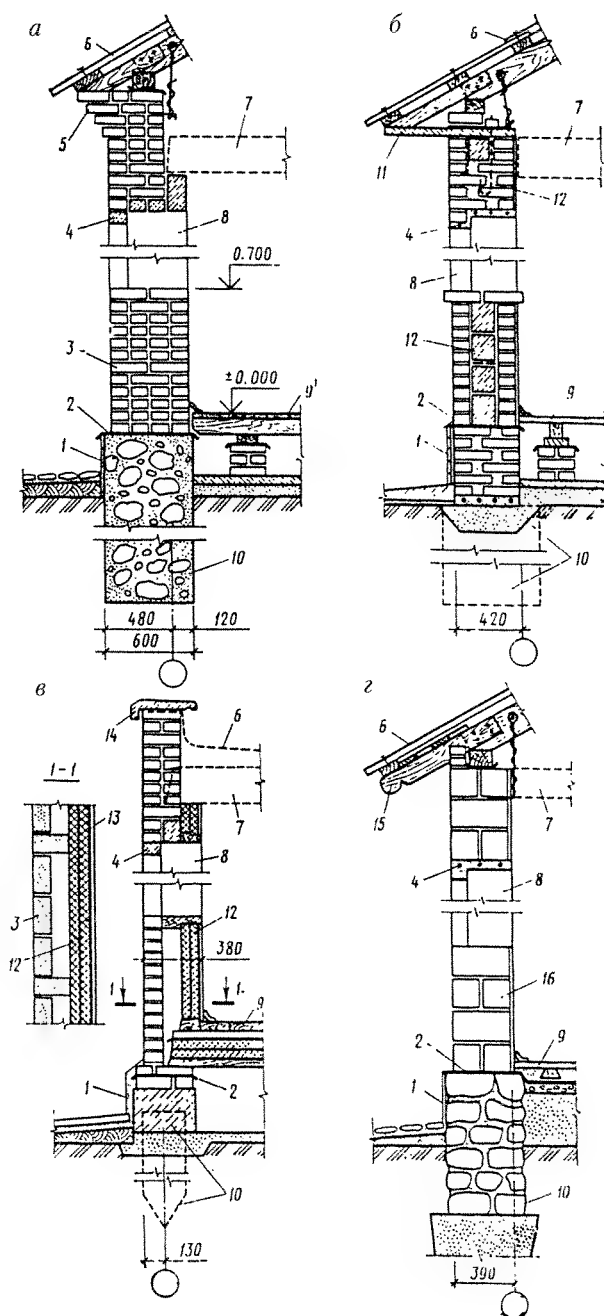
Примеры решения наружных стен одноэтажных жилых зданий из искусственных камней ручной кладки в композиции с элементами дома:
